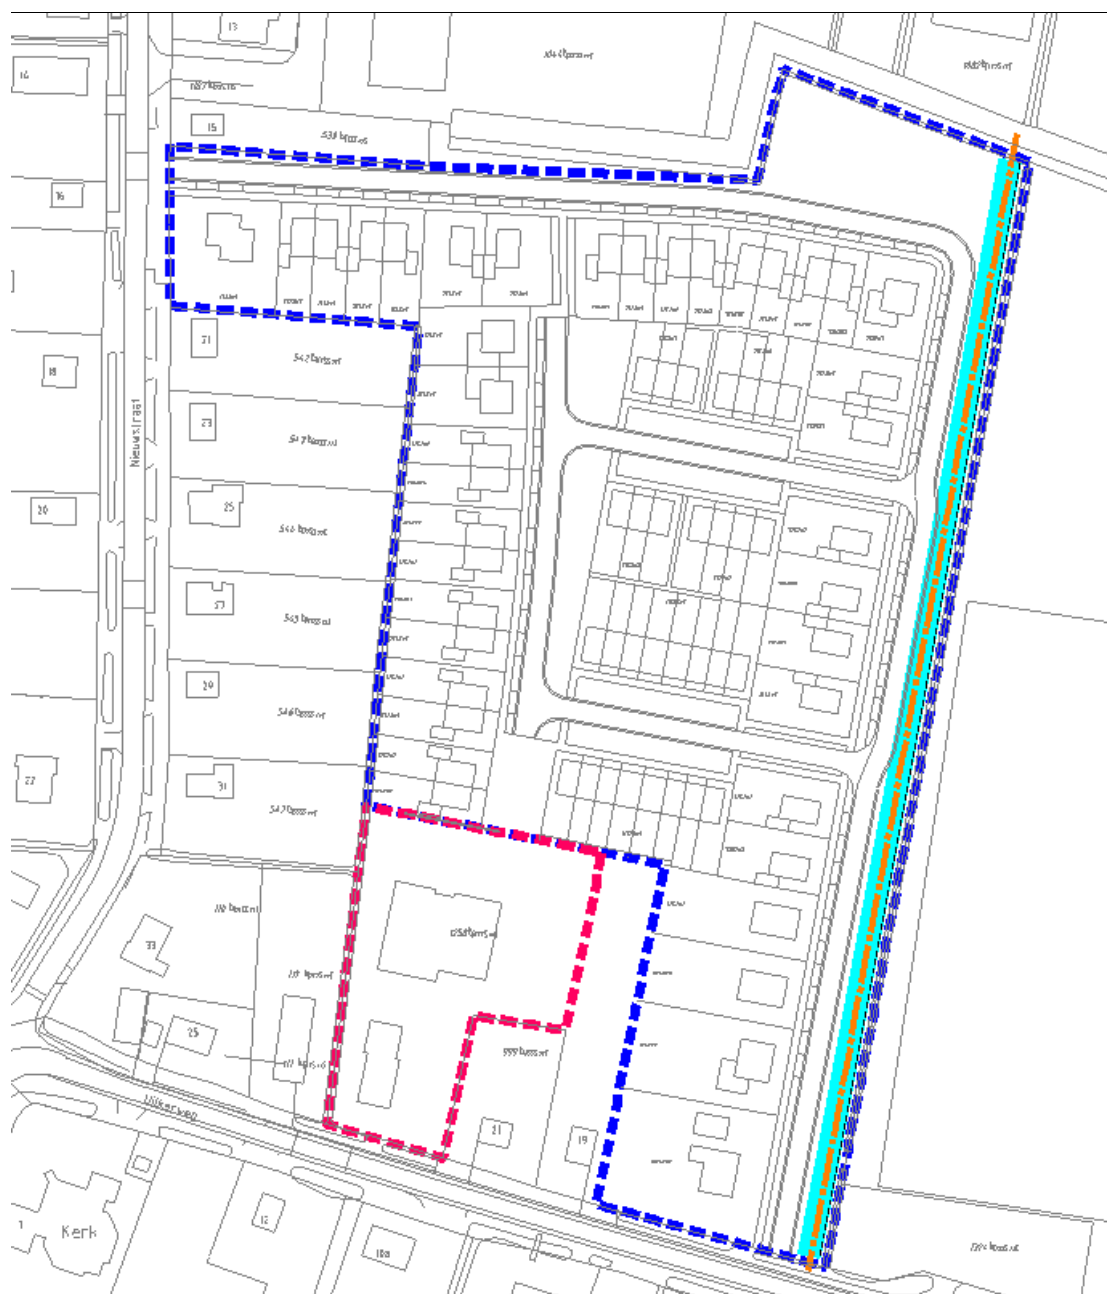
Boveenaanzicht mogelijke overstortconstructies
